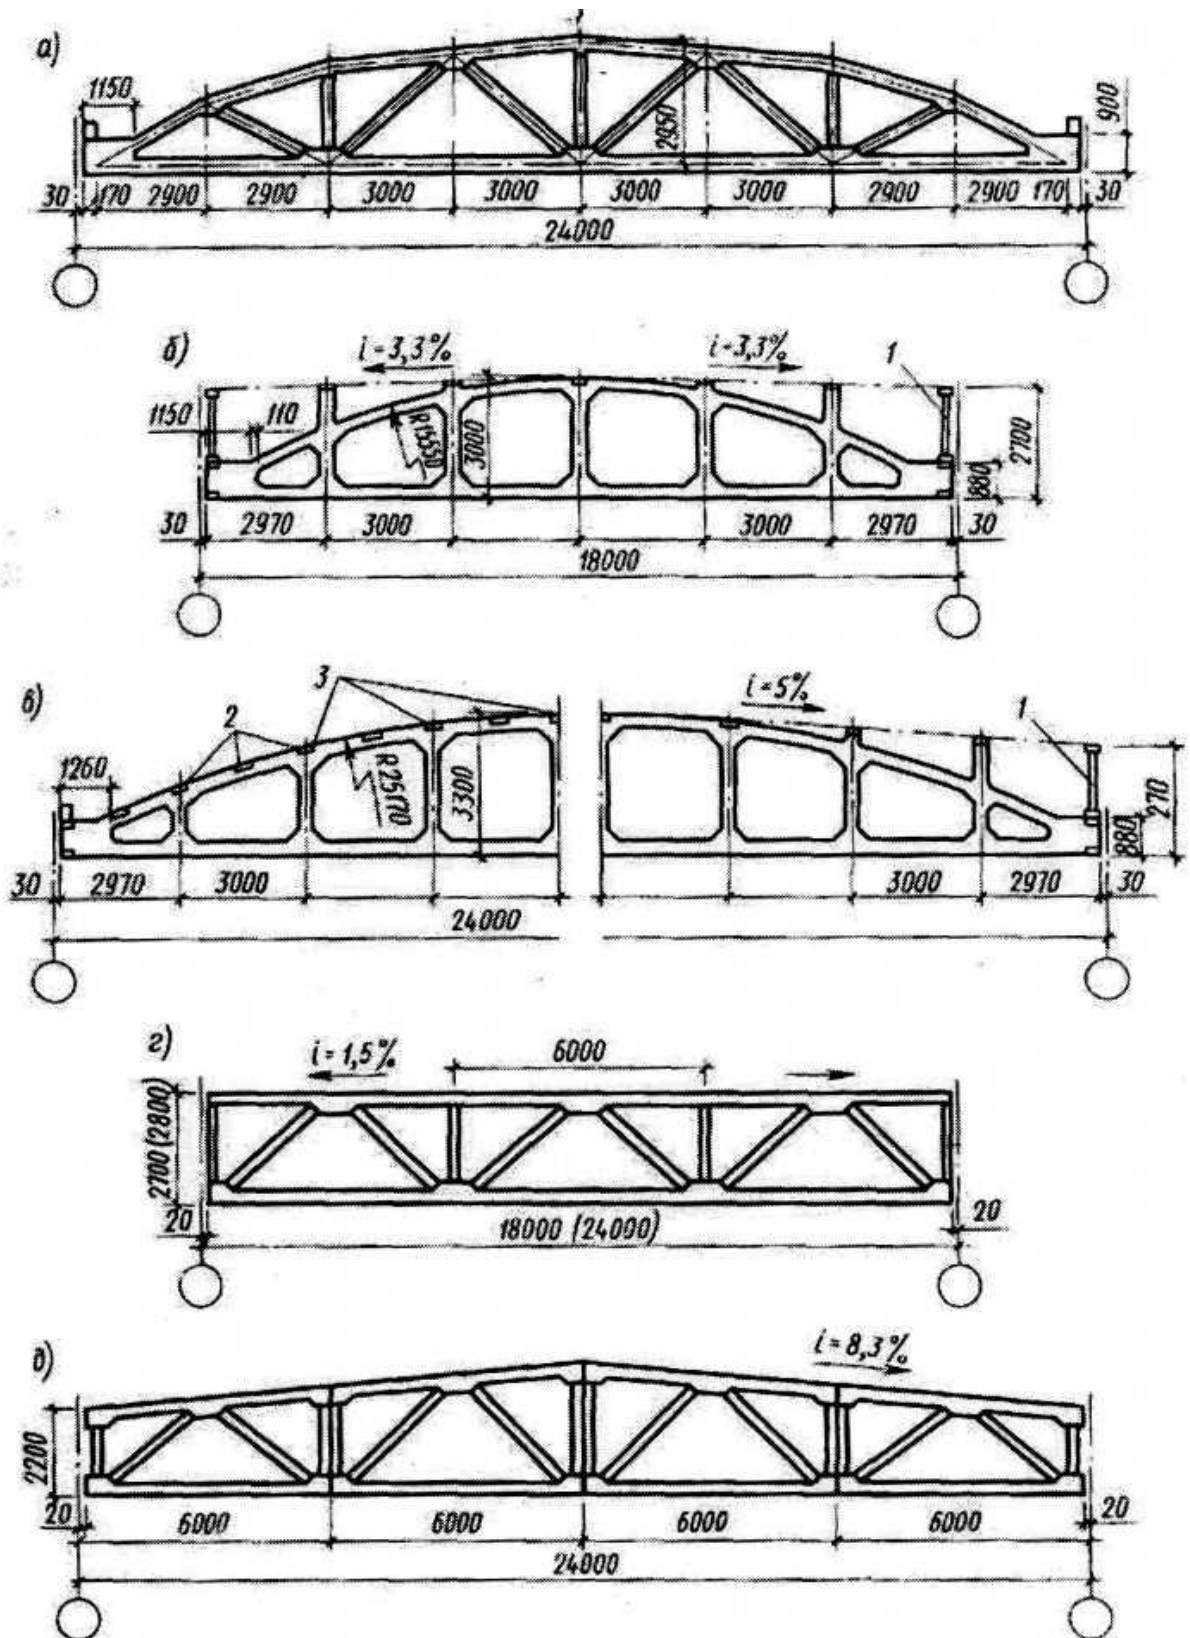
Железобетонные стропильные фермы: а — сегментная раскосная ферма для скатной кровли; б-безраскосная ферма для малоуклонных кровель пролетом 18 м; в - безраскосная ферма для скатной кровли и малоуклонной кровли пролетом 24 м; г-с параллельными поясами; д- полигональные сборные фермы; 1 - стальная стойка; 2 - закладные детали для плит шириной 1.5 м; 3- то же, 3 м
